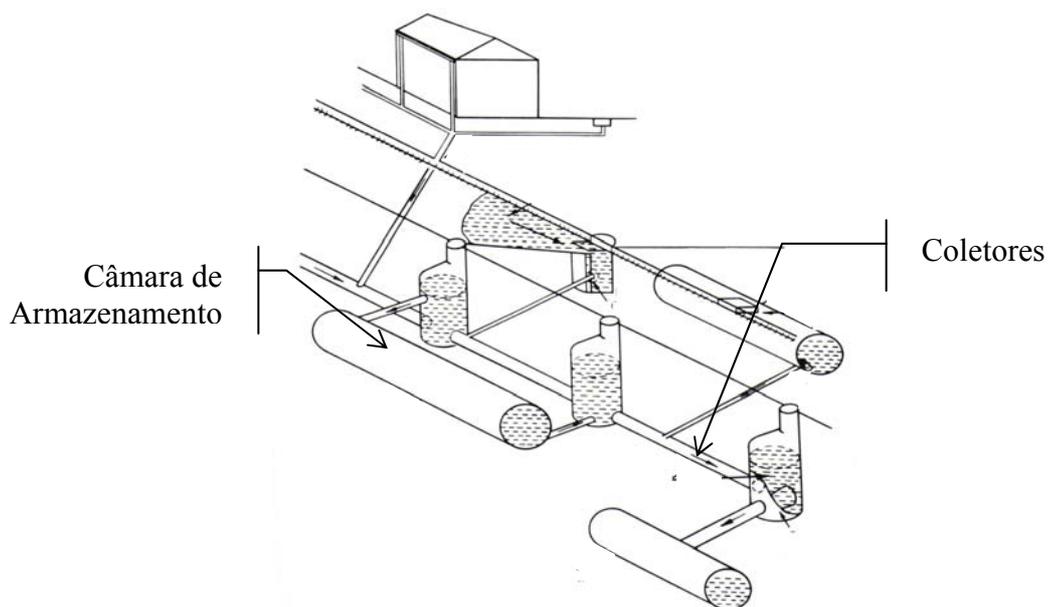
Câmaras de Armazenamento, em paralelo (adaptado de Force, 1992a)
